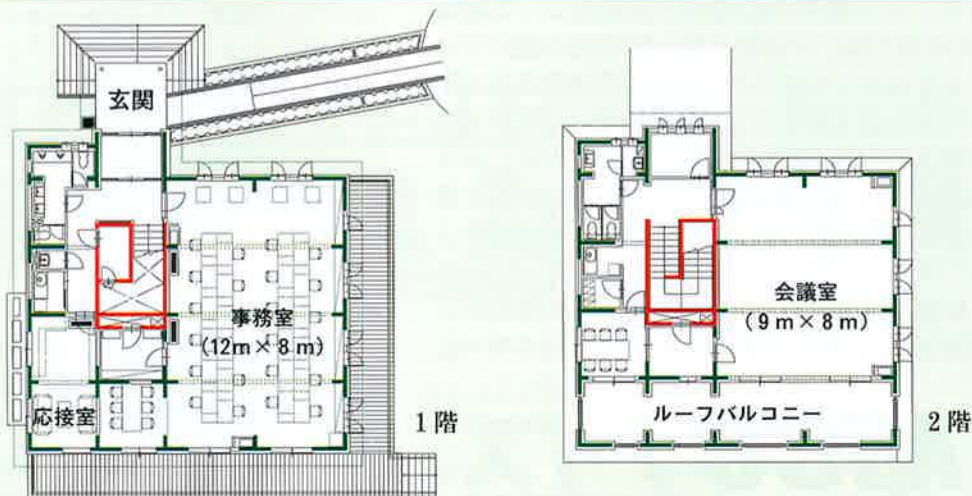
平面図(緑がCLT部分、赤が鉄筋コンクリート造部分)
